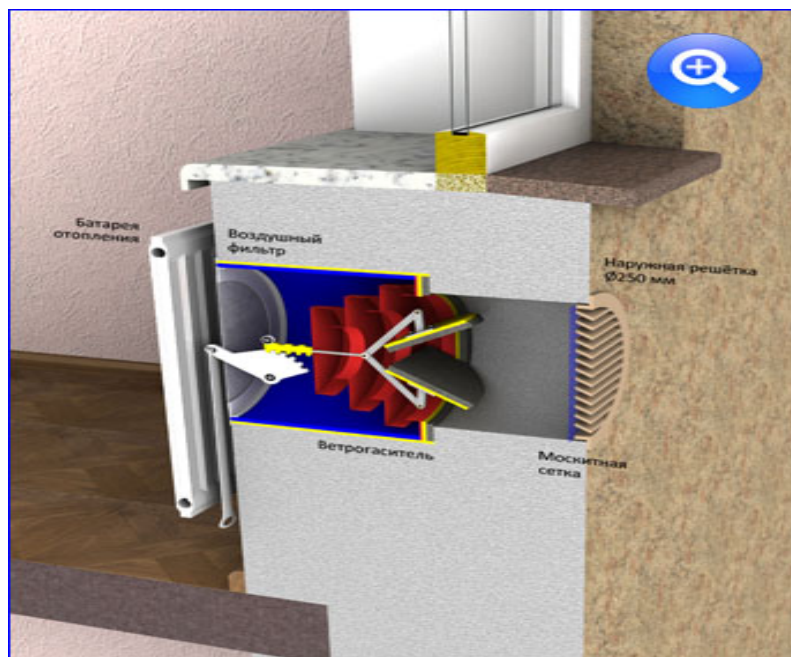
Вентиляционный клапан ООО «Овен», установленный в наружной стене здания
